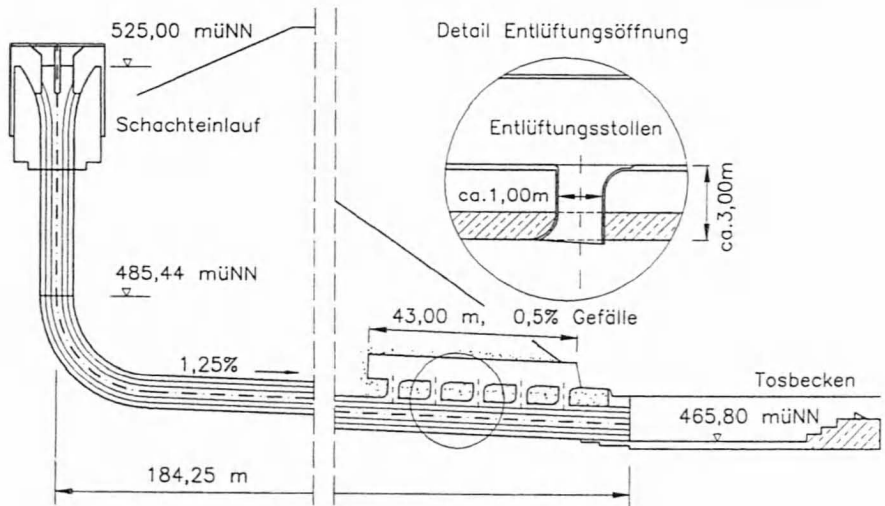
Längsschnitt durch die Hochwasserentlastungsanlage nach der Sanierung
